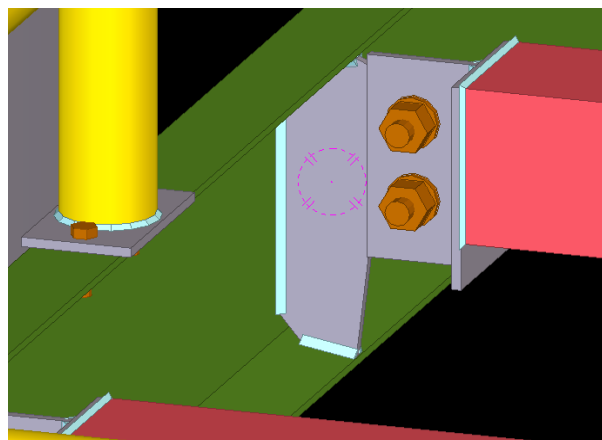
Conexión pernada a cortante que une la vigueta PTE con la viga C. Fuente:
